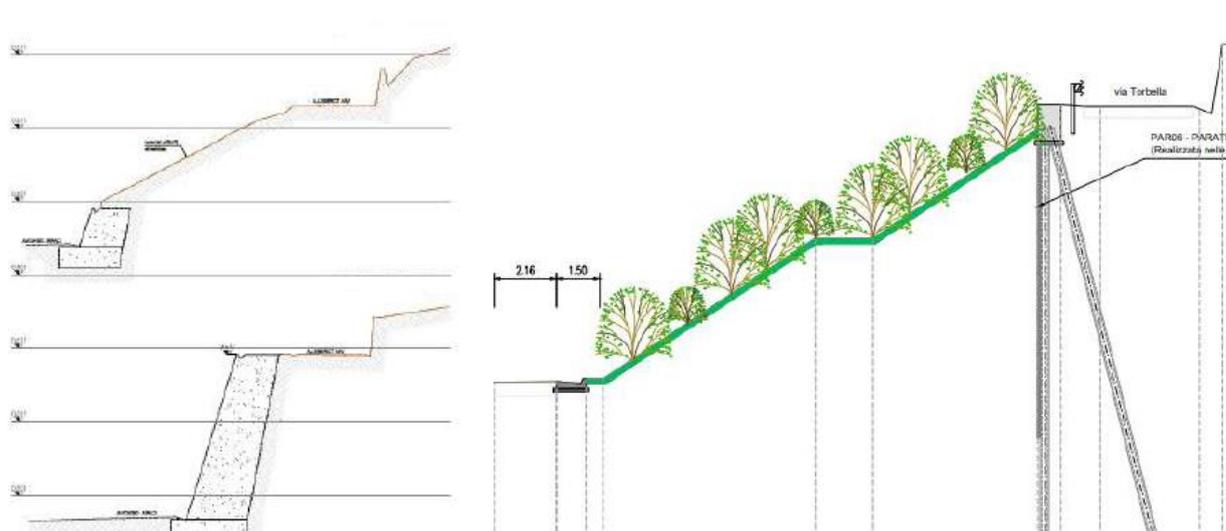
a sinistra: geometria del muro contro terra a gravità non armato posto in aderenza alla carreggiata ovest della piattaforma autostradale A12. A destra: ricostruzione del fronte collinare prevista dal progetto in Valutazione Preliminare.
